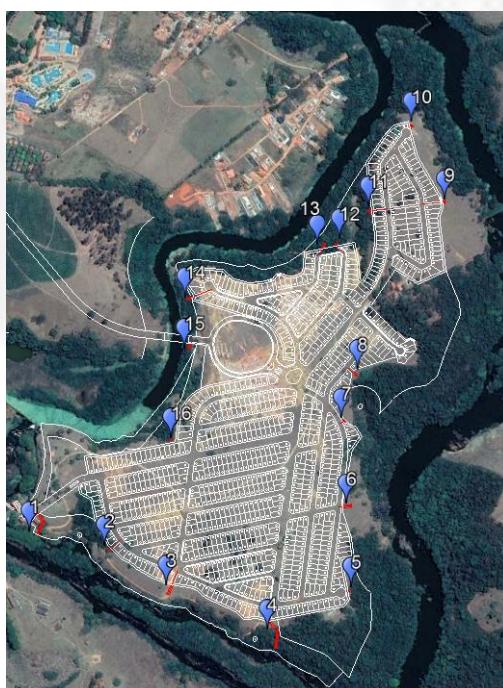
Traçado urbanístico e pontos de implantação dos dissipadores
